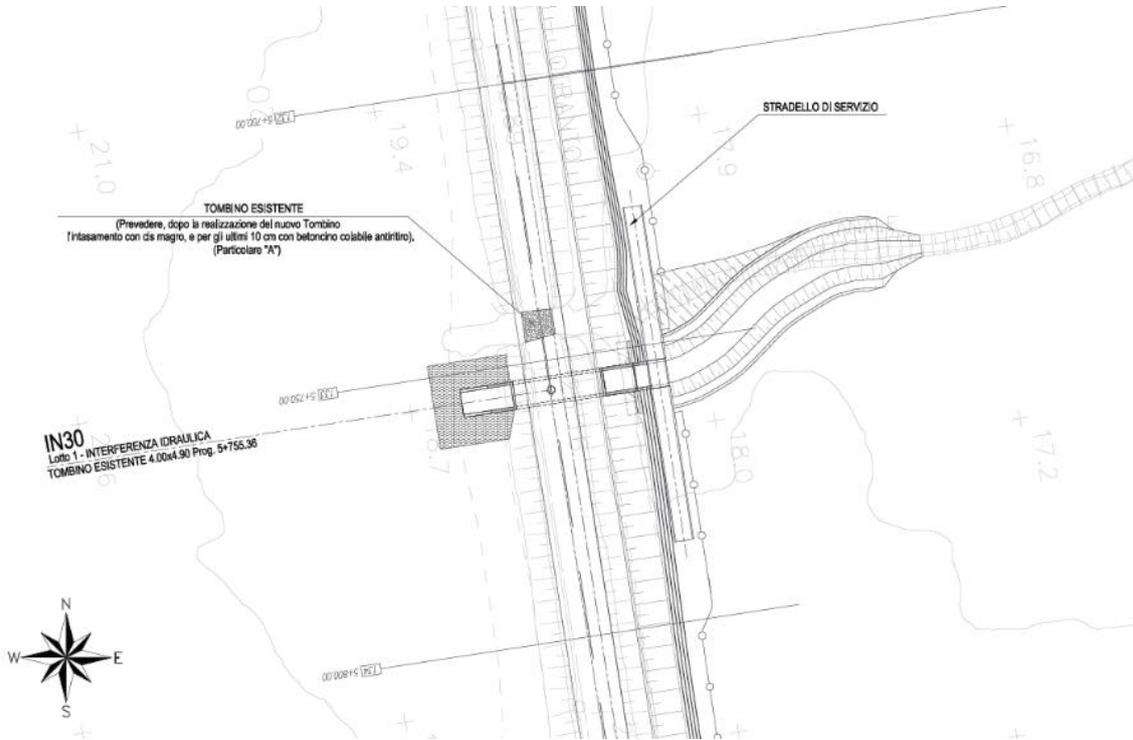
Adeguamento idraulico Fosso Capoposta – Vista Planimetrica
